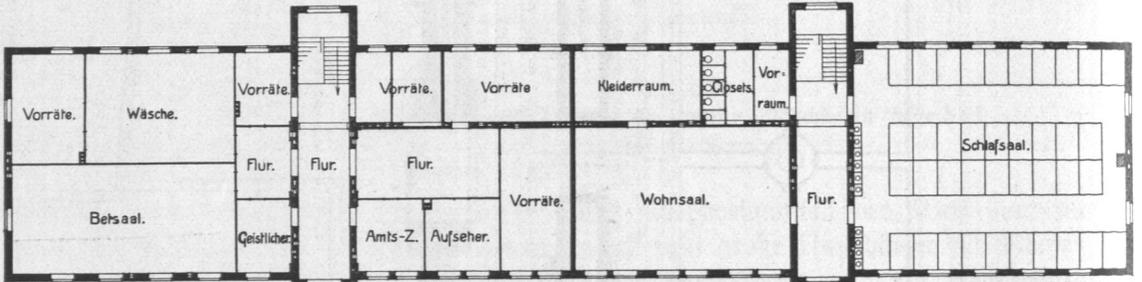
Werk- und Armenhaus in Farmsen, großes Frauenhaus, Obergeschoß, Grundriß.
